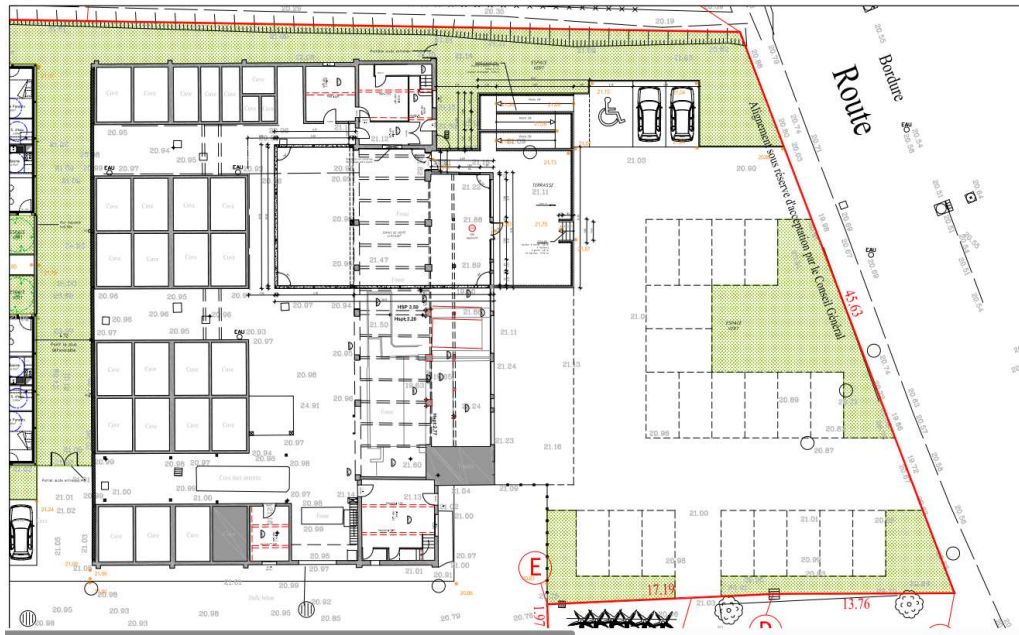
Tranche 1 - 2014 – Plan Cave Coopérative maintenue et Plan nouveau Caveau de Vente
